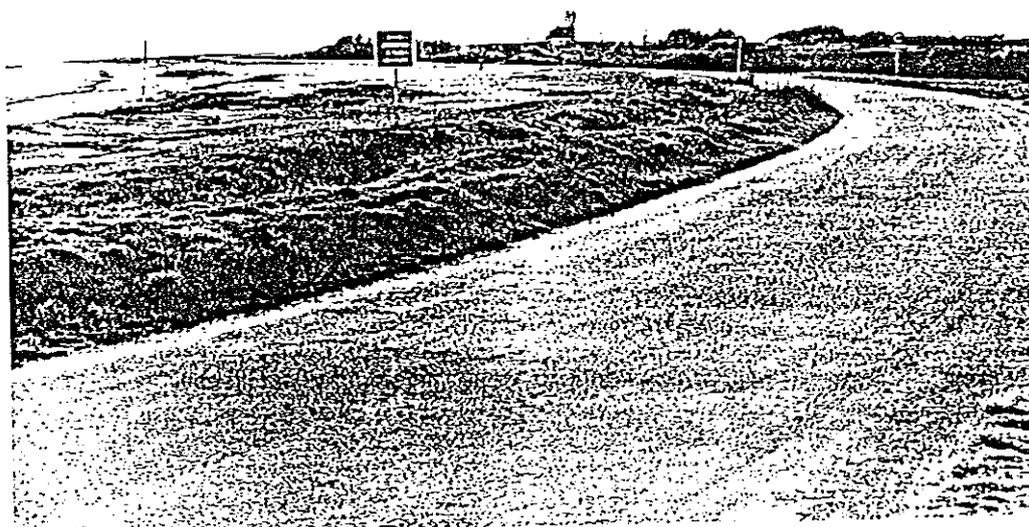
Le tracé suit la route qui mène aux PIERRES PLATES
